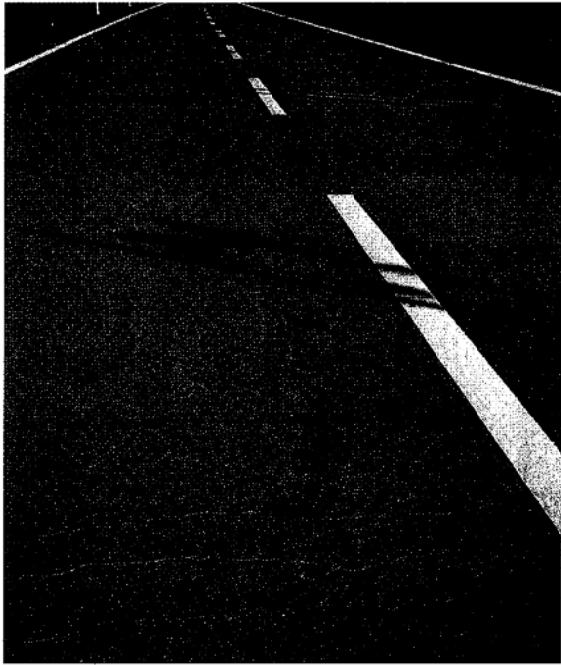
破損の種別：連続鉄筋コンクリート舗装の縦ひび割れ	破損の程度：L
